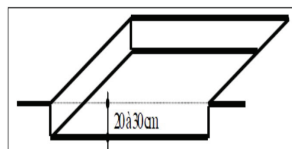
Fouilles en pleine masse ou en excavation : Il englobe des travaux d'envergure aussi bien en surface qu'en hauteur.
